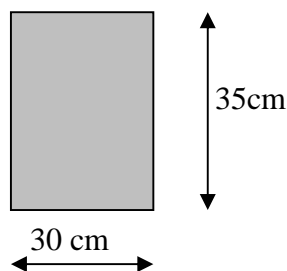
Les dimensions de la poutre de chaînage.
